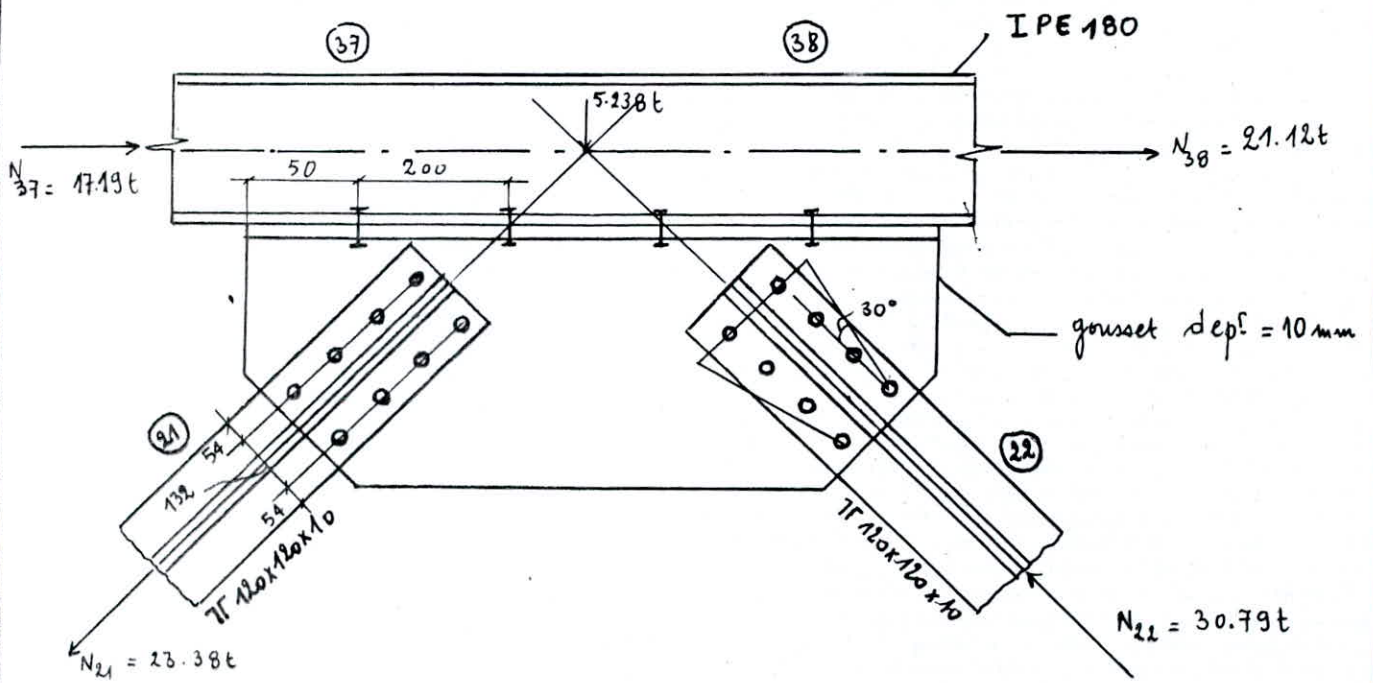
Assemblage diagonale - gousset - poutre: (Voir fig ci dessous)
